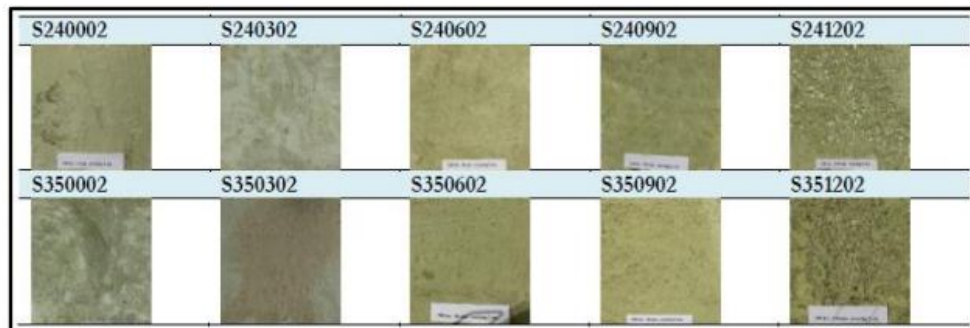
Superficie de hormigón expuesta al fuego. T. Daungwilailuk et al. (2017). Evaluating Dmaged Concrete Depth in Reinforced Concrete Structures under Different Fire Exposure Times by Means of NDT and DT Technique
